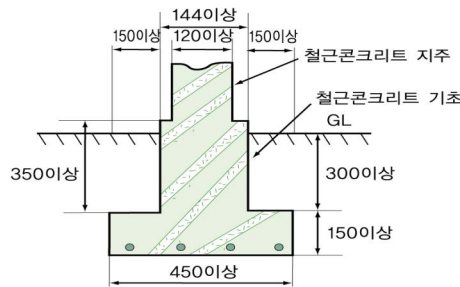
③ 철근콘크리트제 방호벽 설치예
